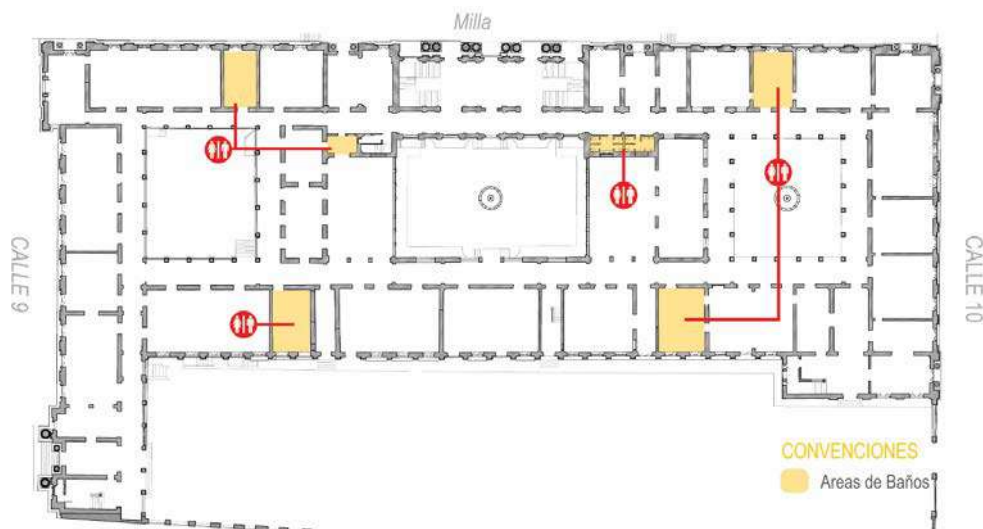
Esquema de ubicación de baños Planta Primer Piso
